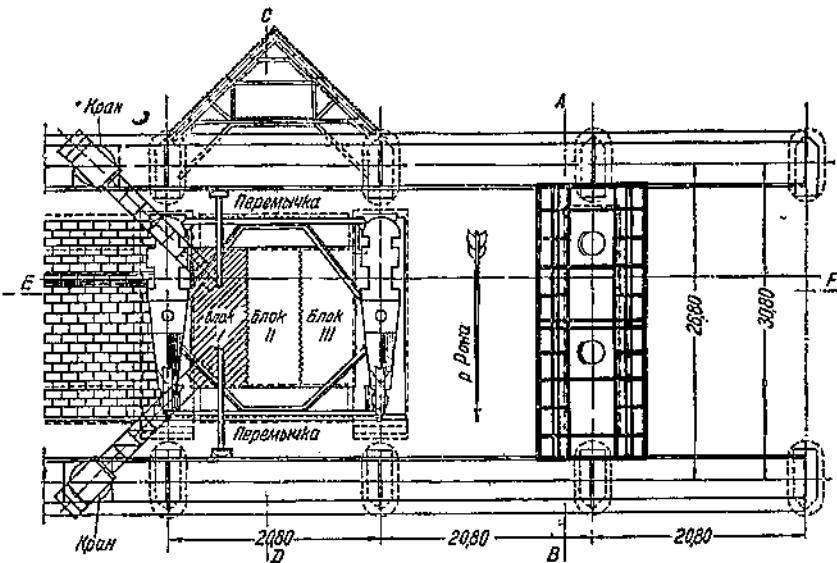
План расположения оборудования для подводного бетонирования флютбета плотины Jons.
